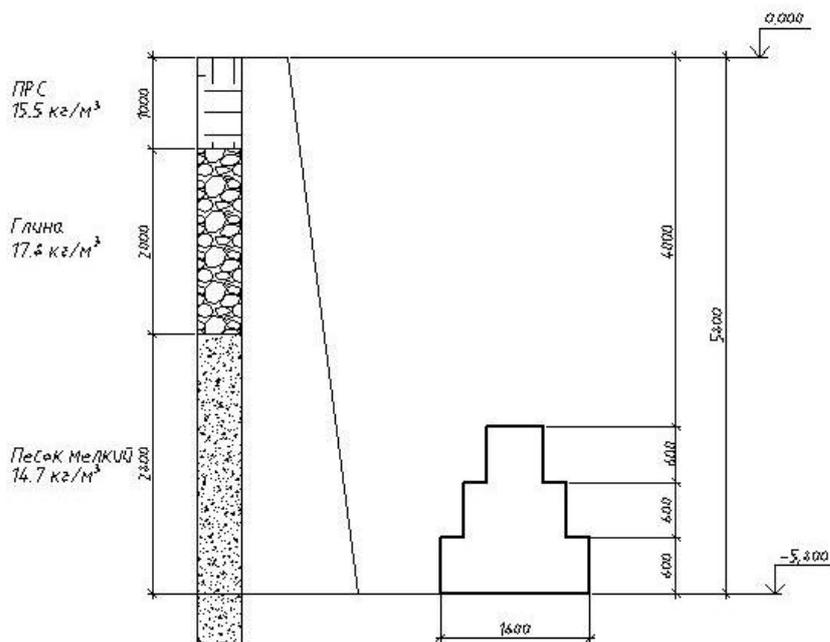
Расчетная схема фундамента под колонну в осях Г1/8
